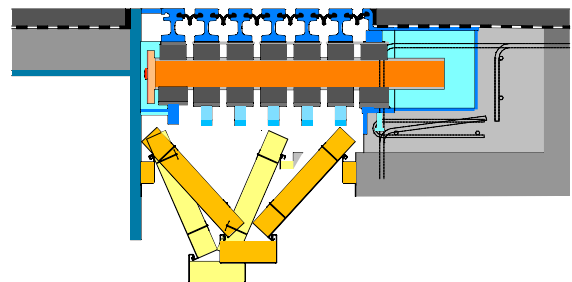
Faltsystem mit schallabsorbierender Dämmkonstruktion
